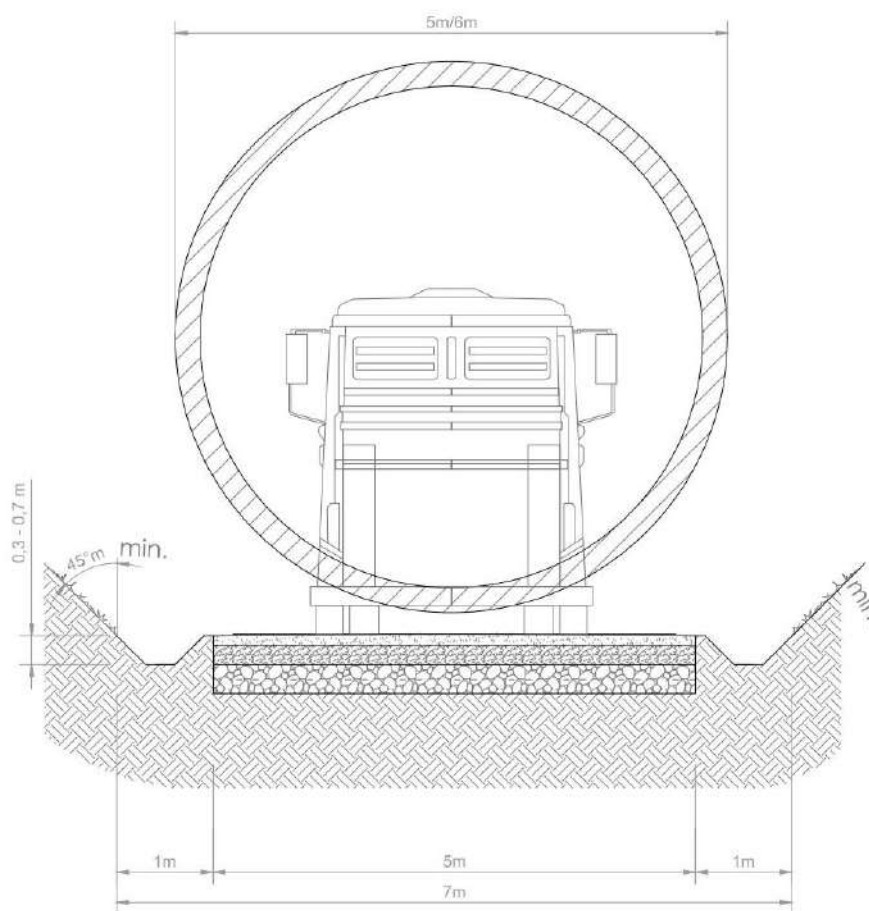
Sezione stradale tipo con rappresentazione dell'ingombro trasporto
